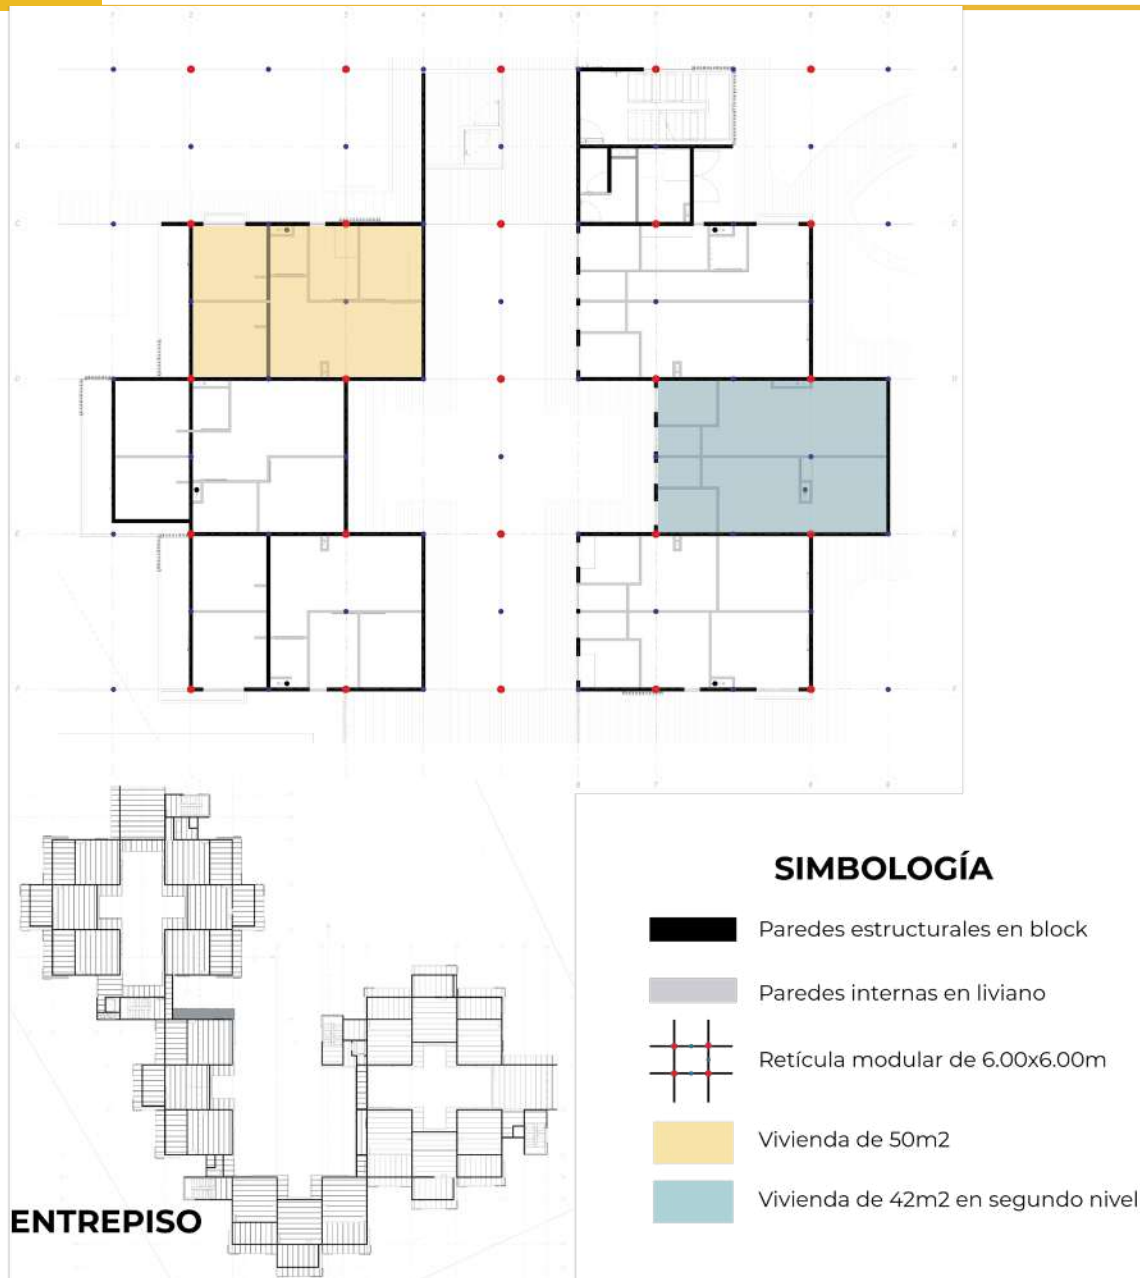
Planta de sistema estructural del proyecto - Bloque C y planta de entrepiso.
